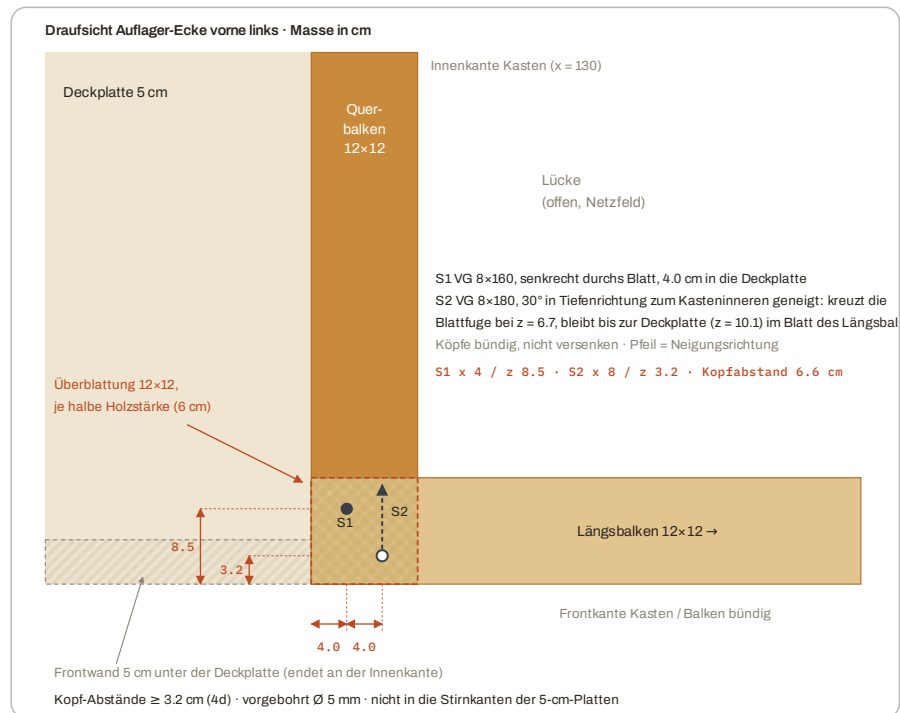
Schraubenplan, Draufsicht Auflagerecke vorne links — massgleich alle vier Ecken, gespiegelt (aus den Projektdaten gezeichnet)
